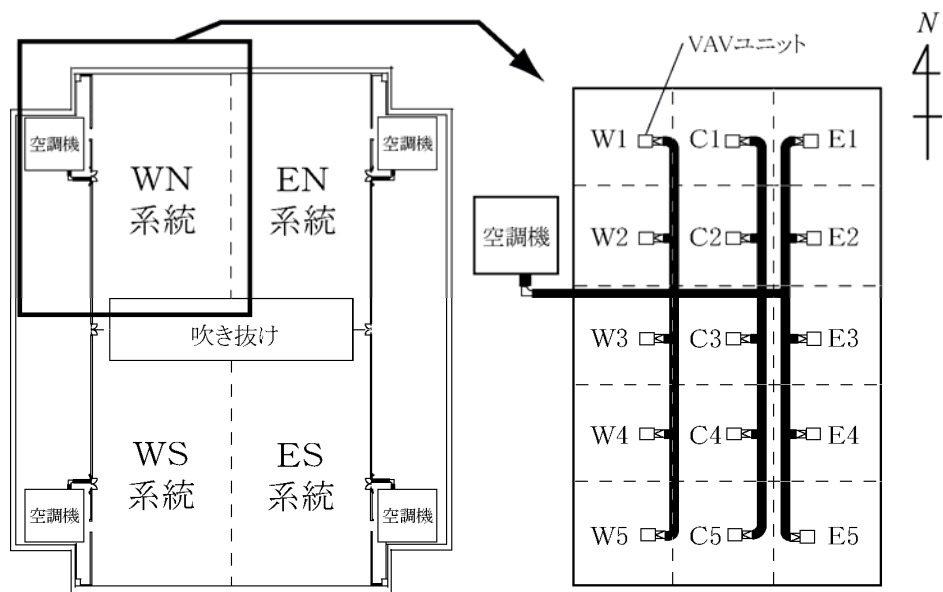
基準階の平面図と VAV ユニット配置図 (WN 系統)
